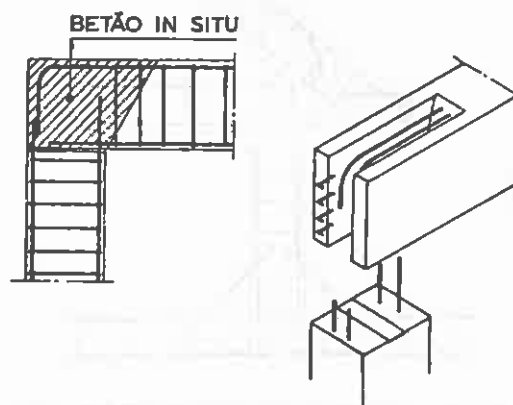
Ligação de vigas fabricadas fabricadas por partes
